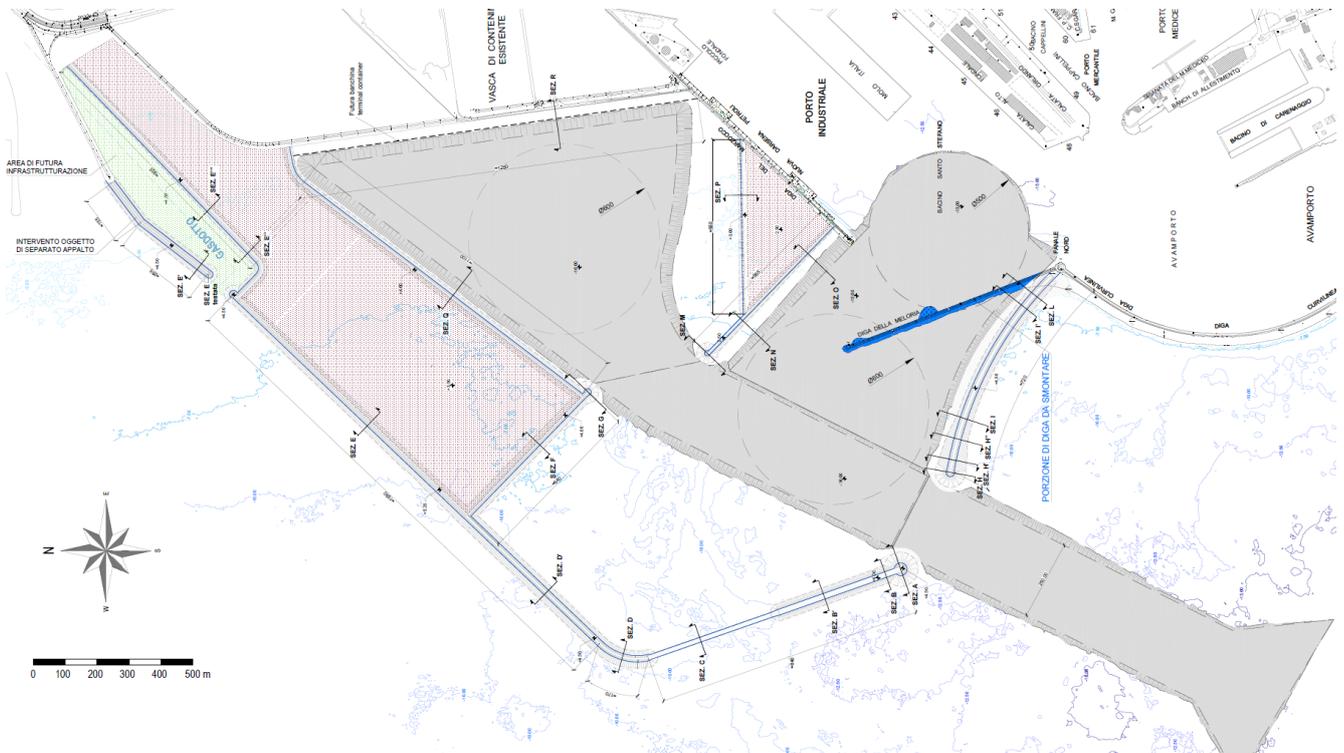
Porto di Livorno - Planimetria degli interventi ricompresi nella progettazione oggetto di affidamento.
